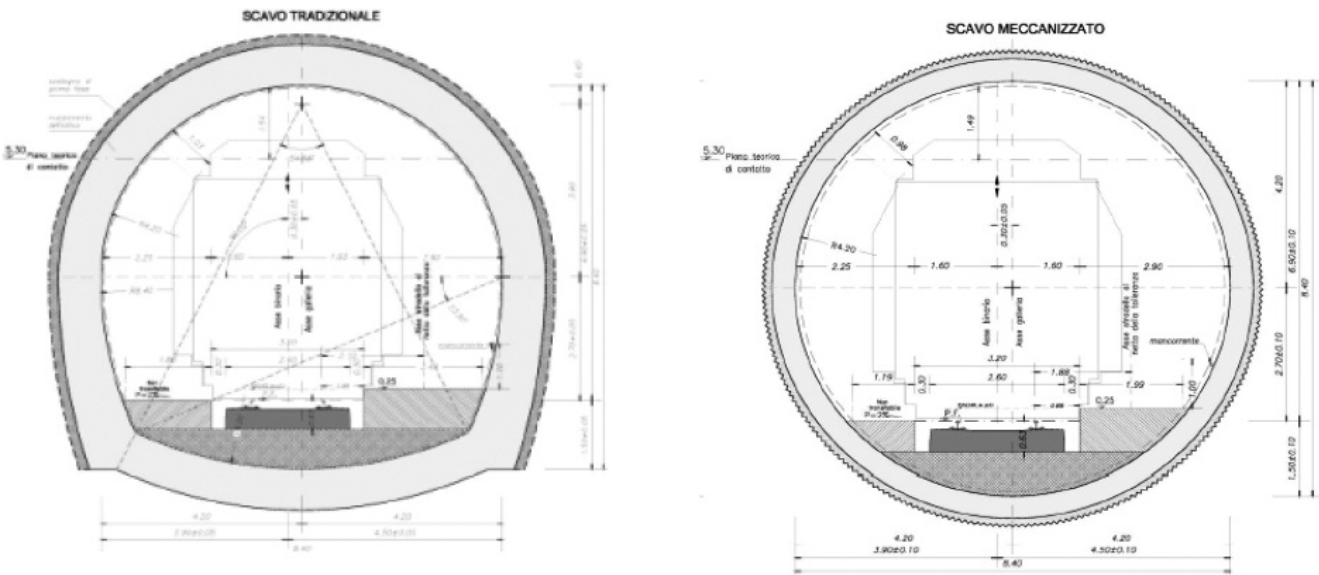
Sezione tipo scavo tradizionale e scavo meccanizzato.
